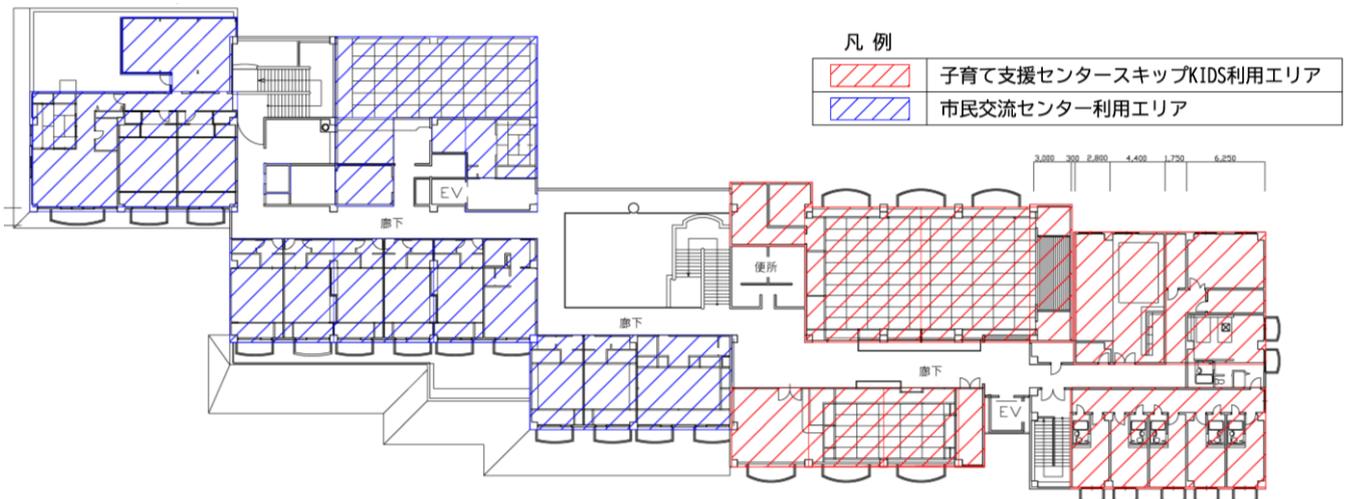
市民交流センター（サンヒル柏原）機能位置図（案）2階平面図
